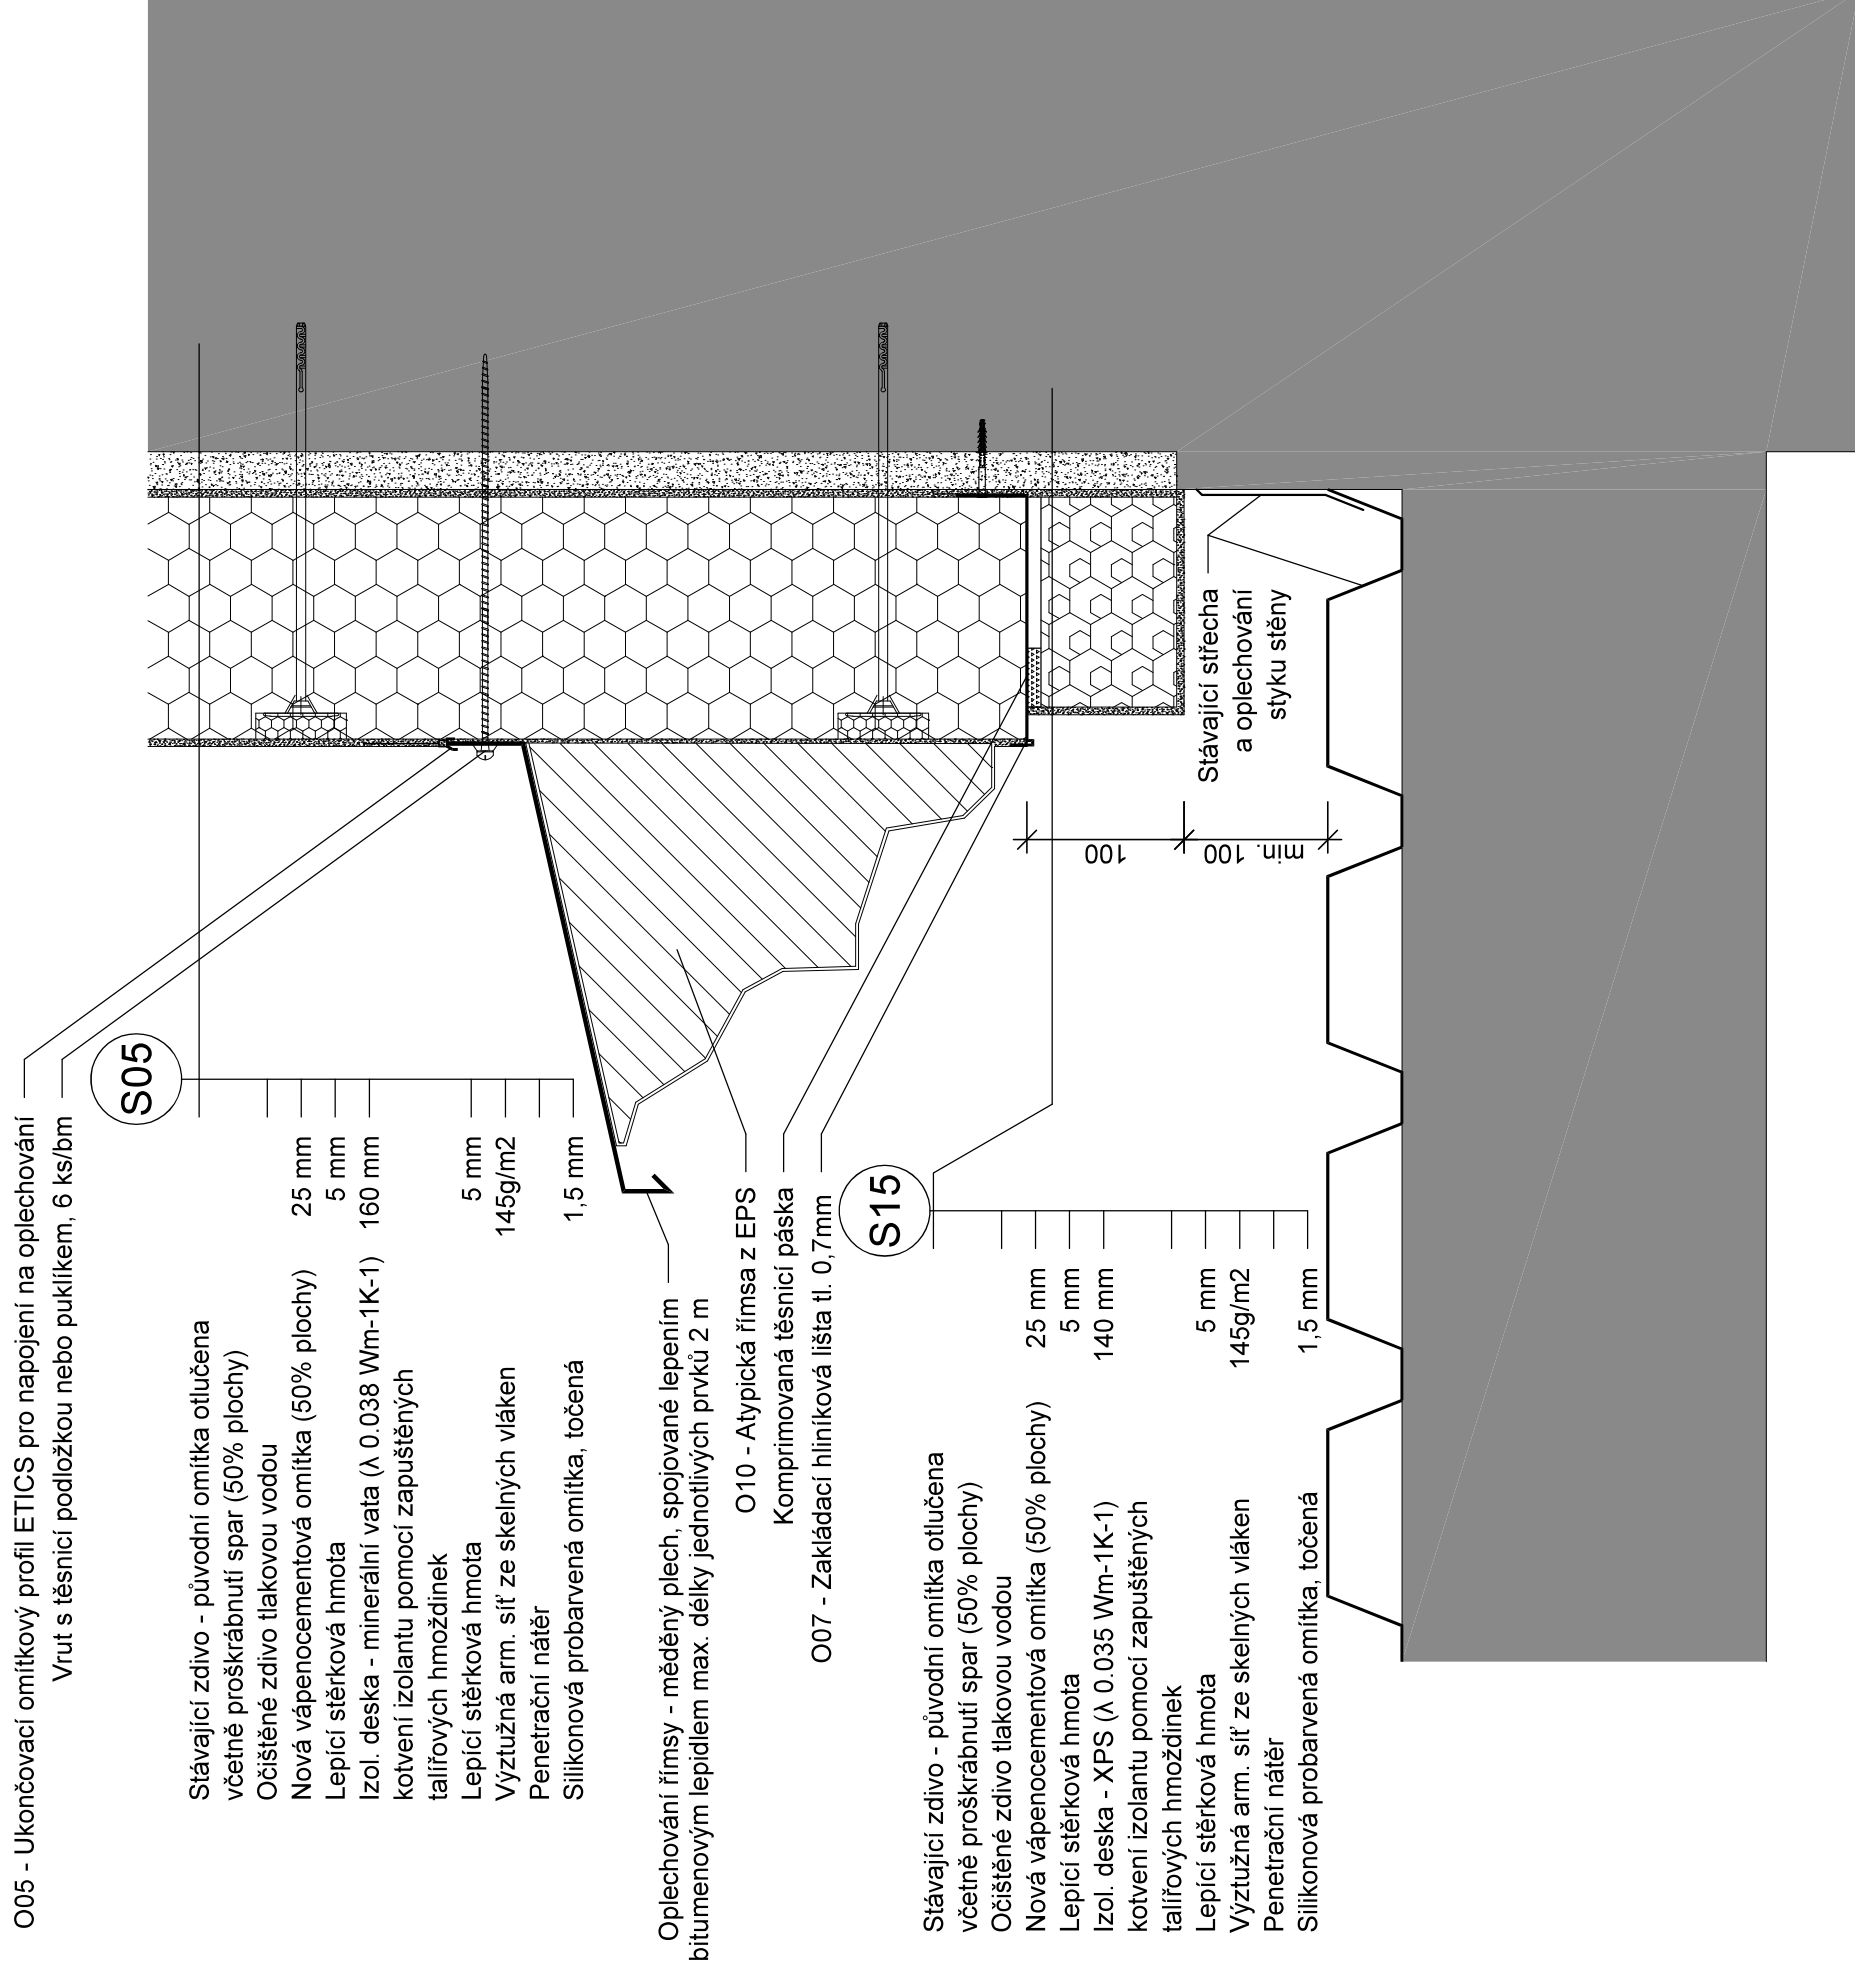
DETAIL UKONČENÍ ZATEPLENÍ U ŠTÍTOVÉ STĚNY
